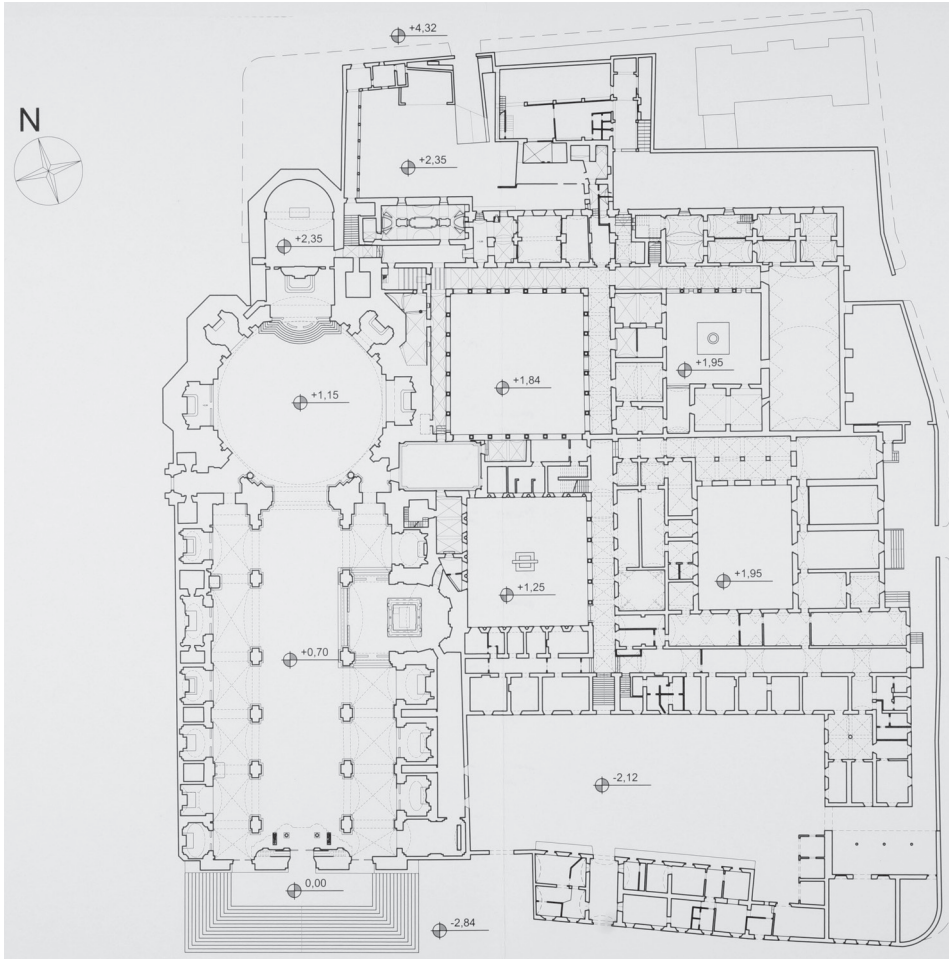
Grundriss von Kirche und Konvent S. Bernardino, L'Aquila (Baufaufnahme 2010)
